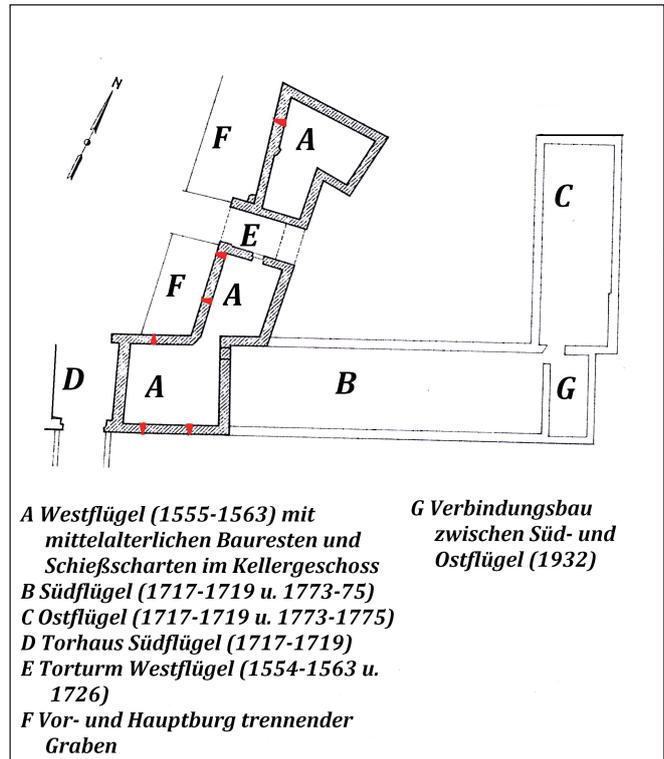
Wijnandsrade. Unmaßstäbliche Grundrisssskizze des Schlosses mit Bauphasen (Zeichnung: Verf., 2012 auf der Grundlage einer Zeichnung des Architekturbüros H. A. M. Beckers).
